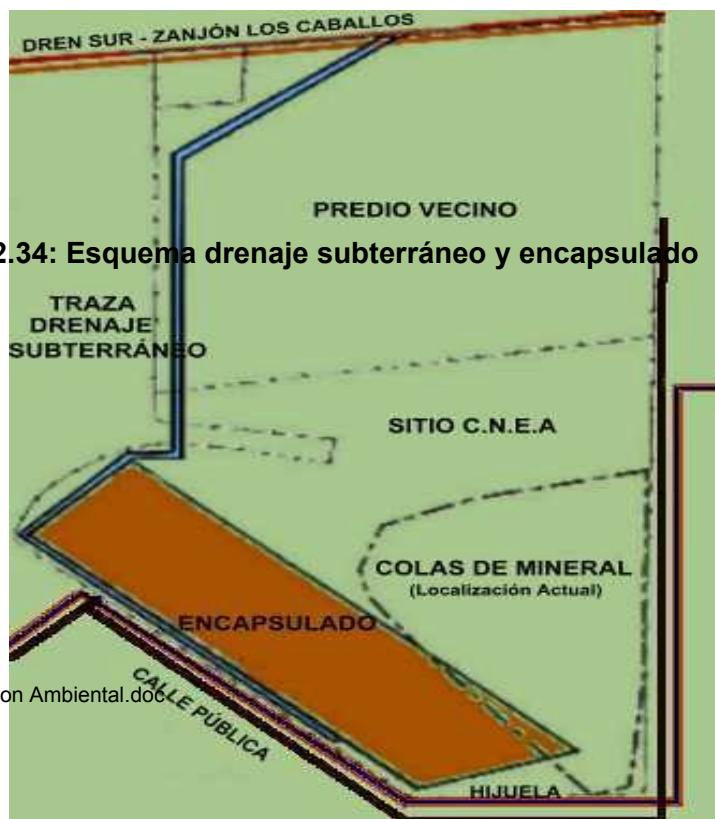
Esquema drenaje subterráneo y encapsulado
